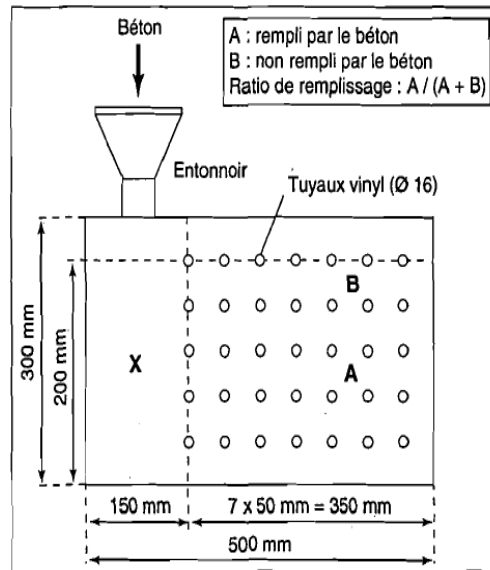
Essai du caisson, d'après Yurugi et al. [25]
